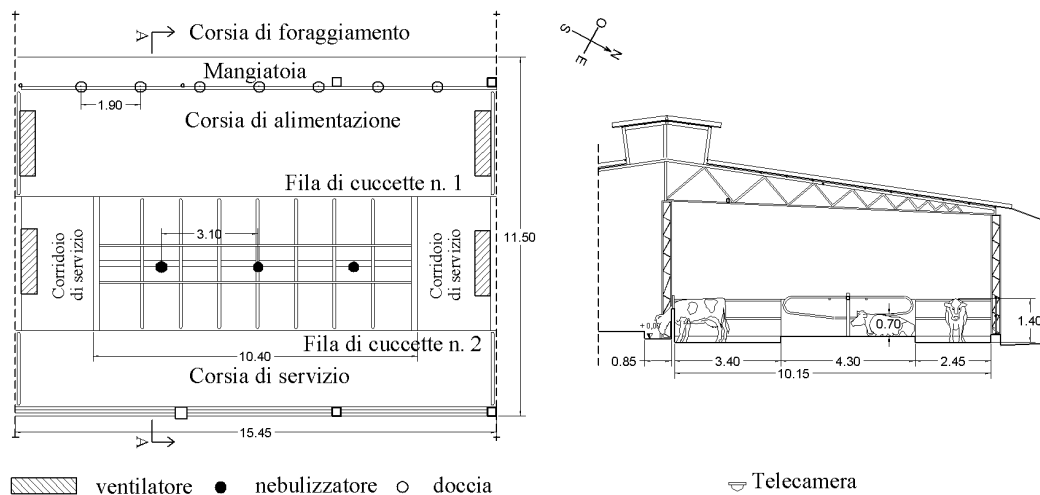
Pianta e sezione dell'area della stalla in cui è stata svolta la prova.
